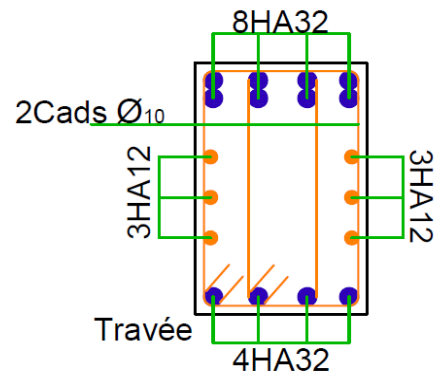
Schéma de ferrailage (section transversale) en travée
